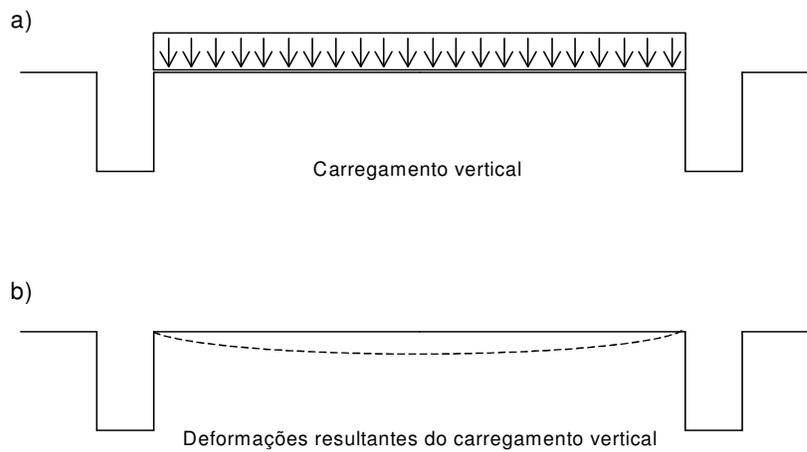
Representação esquemática das fôrmas da laje: a) carregamento; b) deformação.
